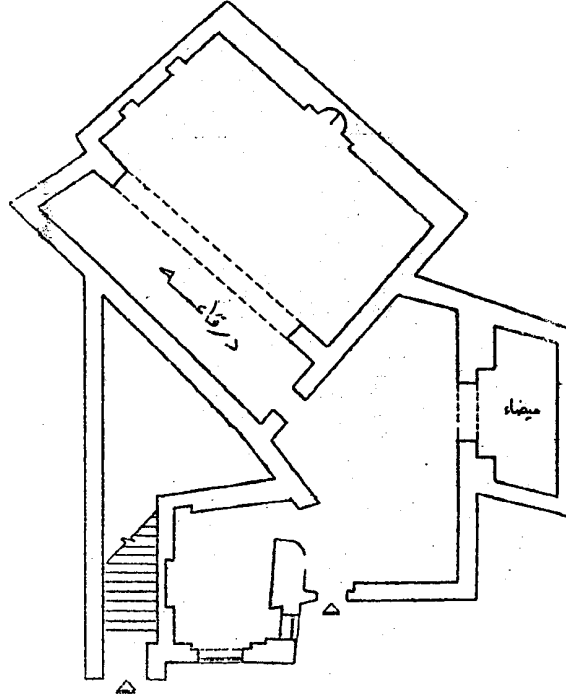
مسقط أفقي لزاوية جسن الرومي
